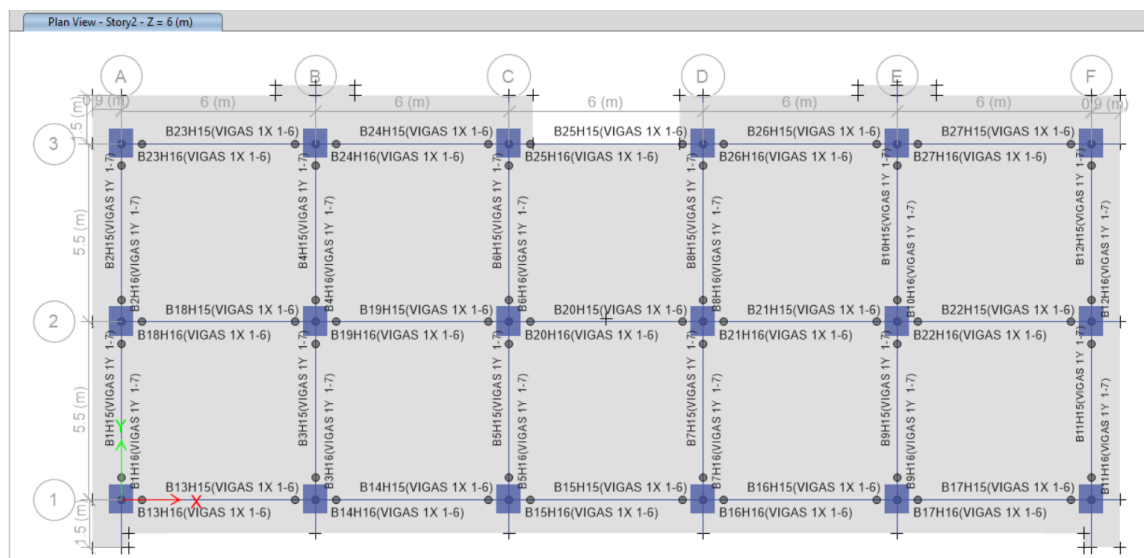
Asignación, longitud y ubicación del tipo de rotulas en vigas
